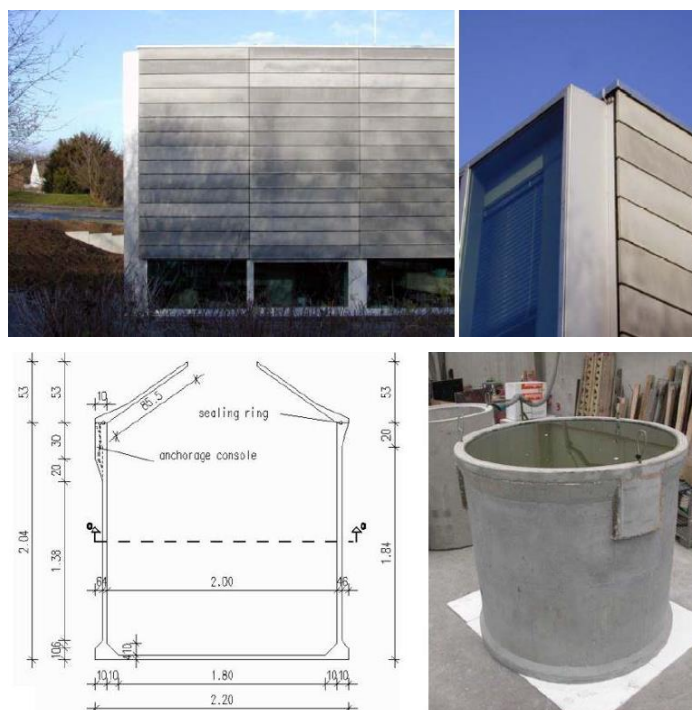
Elementos de fachada e tanque para estação de tratamento de efluentes em concreto têxtil
